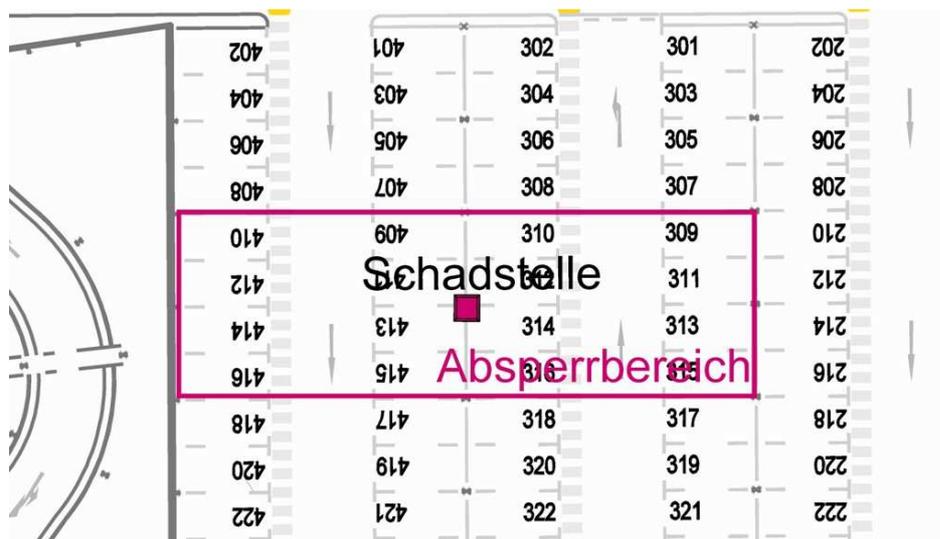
Auszug aus Grundriss Ebene 03 mit Darstellung der Schadstelle und des Absperrbereiches
